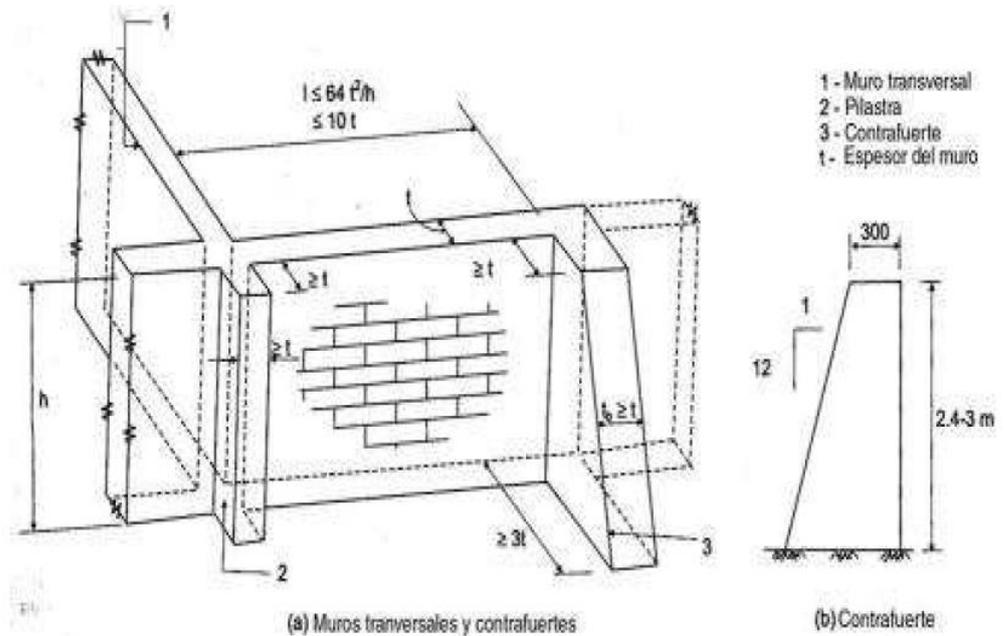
Dimensiones para la construcción de contrafuertes y pilastras.
